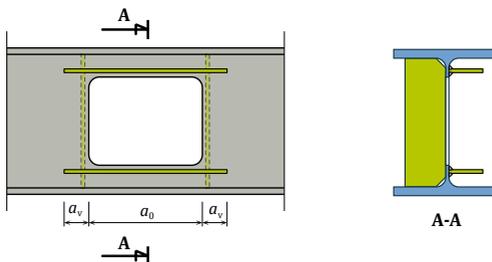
Raidissage longitudinal et transversal d'une ouverture d'âme rectangulaire
